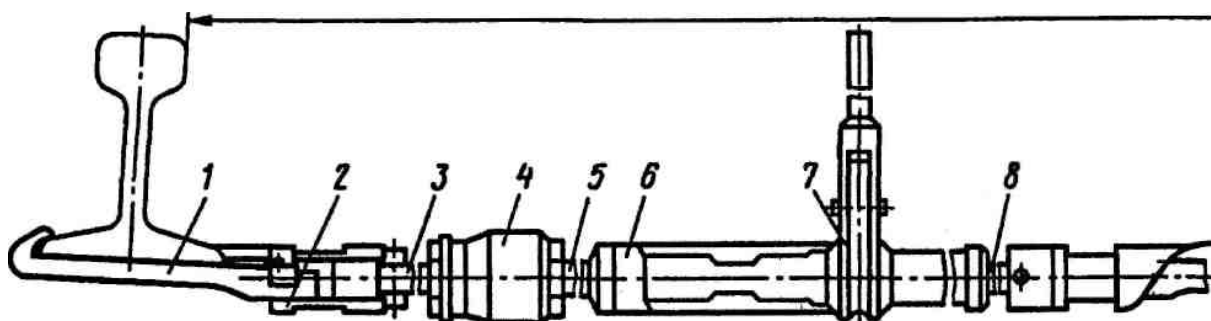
Стяжной прибор для регулировки ширины рельсовой колеи:
